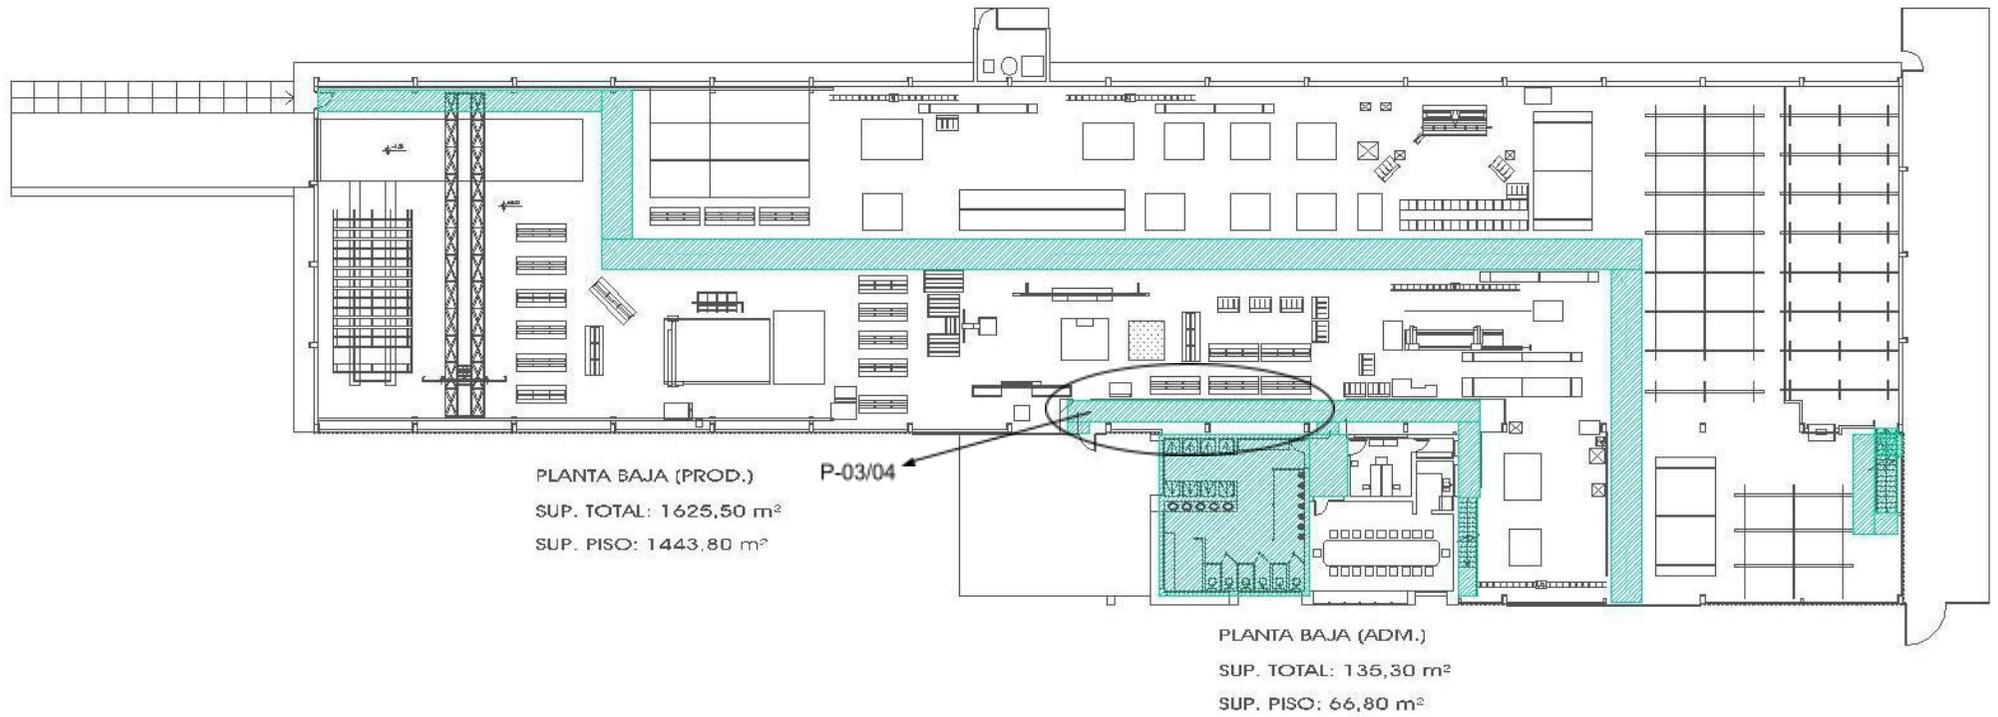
Superficies de Piso Sectores: Planta Baja (Prod.) y Planta Baja (Adm.)
